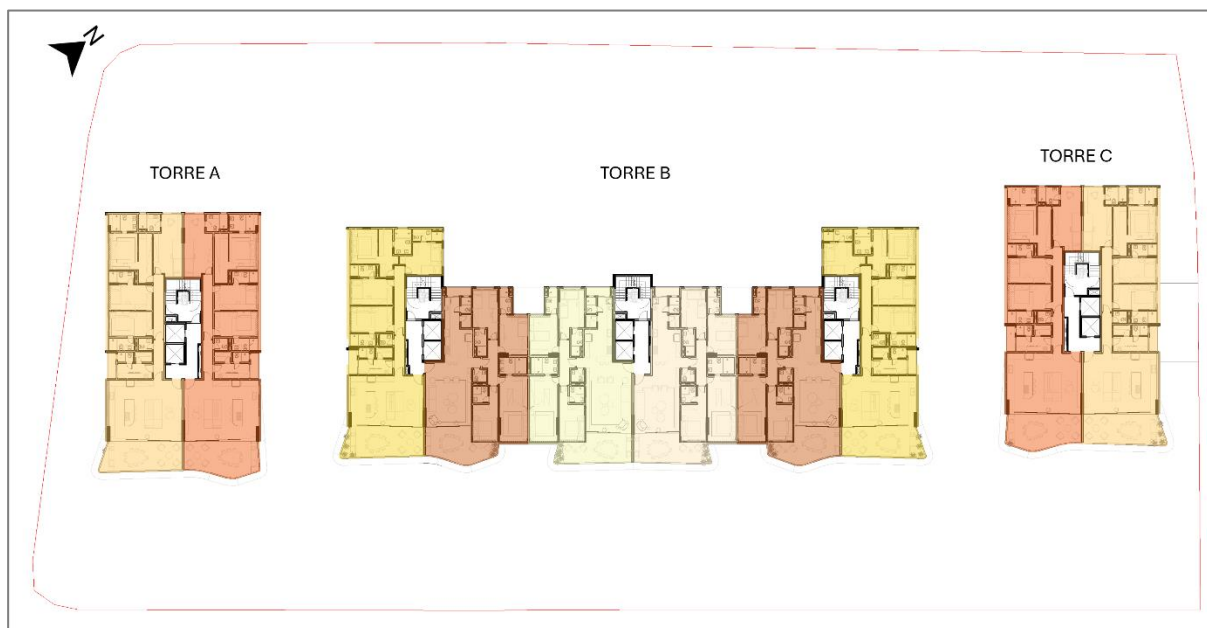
Planta baixa esquemática do pavimento tipo (9 x).
